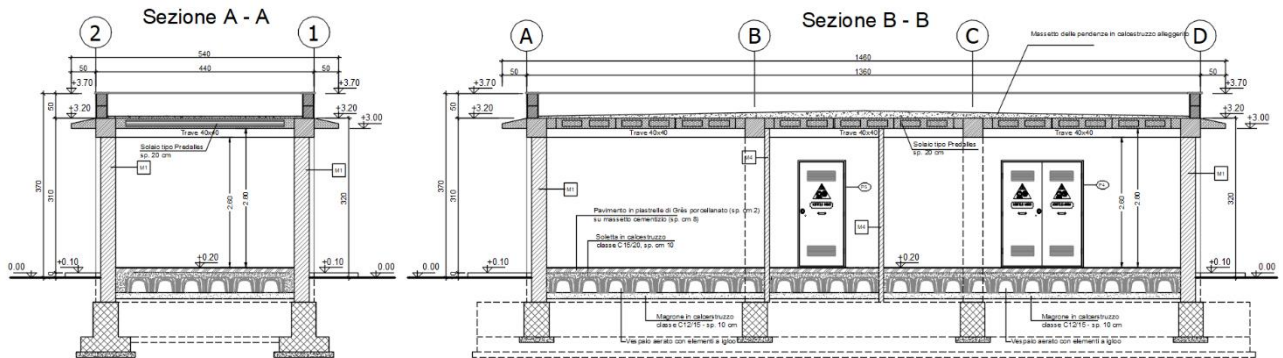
Edificio ENEL – Sezione A-A e B-B
